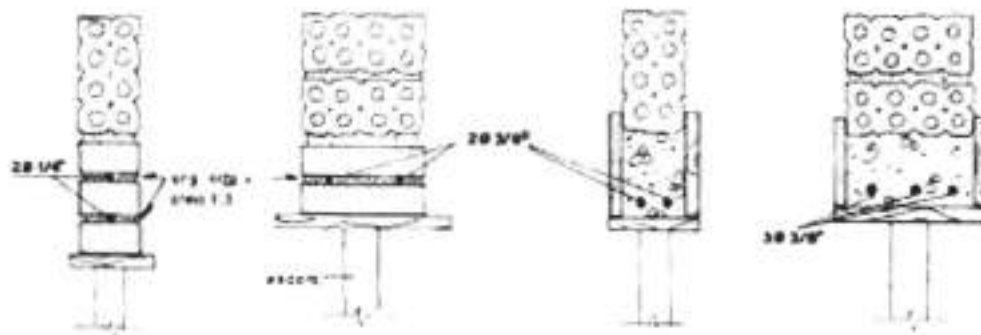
Vergas em alvenaria de tijolo furado para vãos até 1,00m e entre 1,00m e 2,00m
